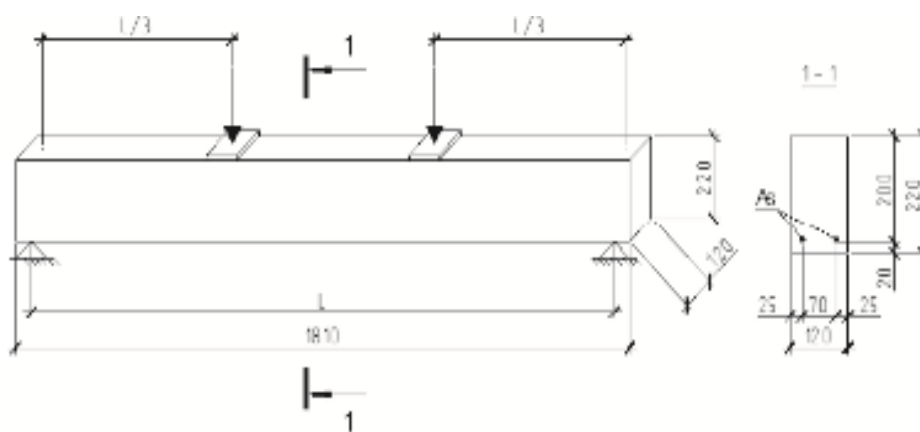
Схема опирания и нагружения исследуемых балок
